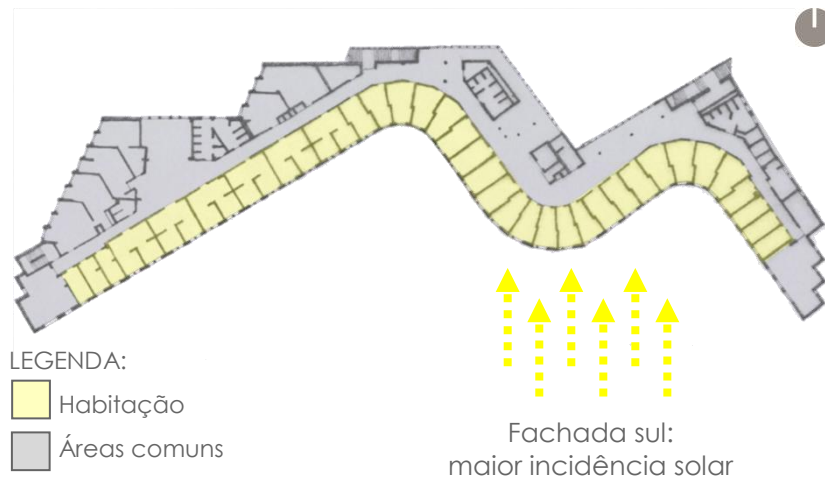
Pavimento tipo | Fonte: greatbuildings.com
